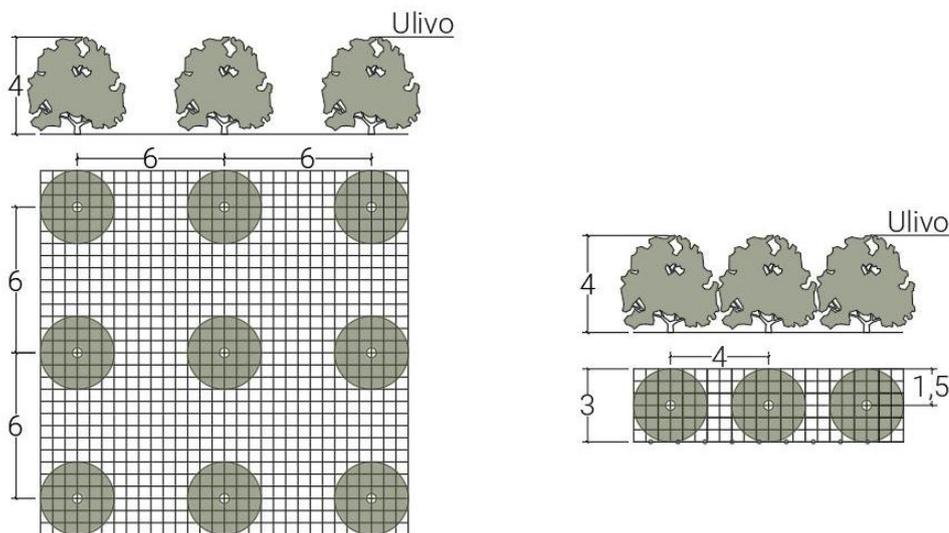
STRALCIO TAVOLA DI MITIGAZIONE
